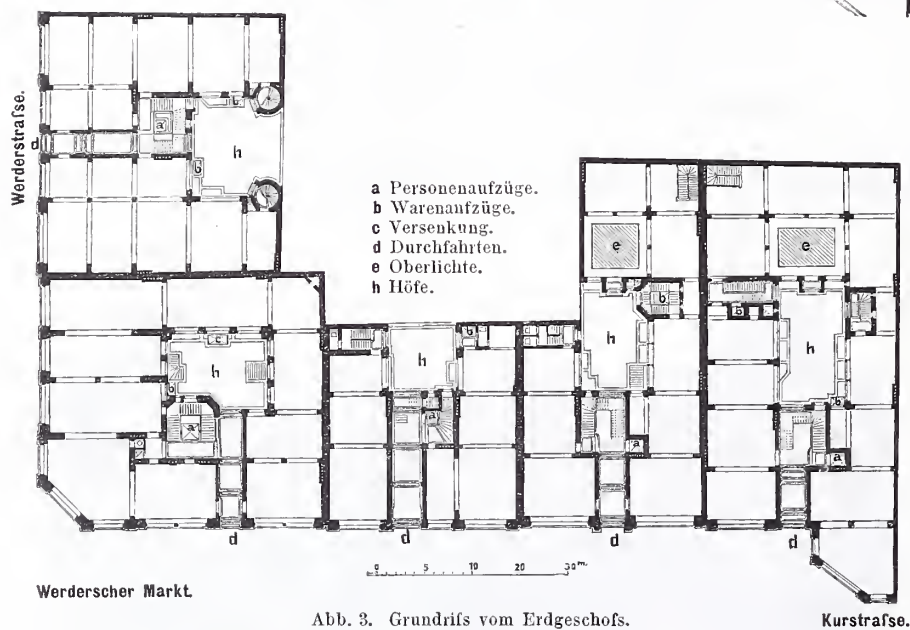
Grundriss vom Erdgeschoss.
